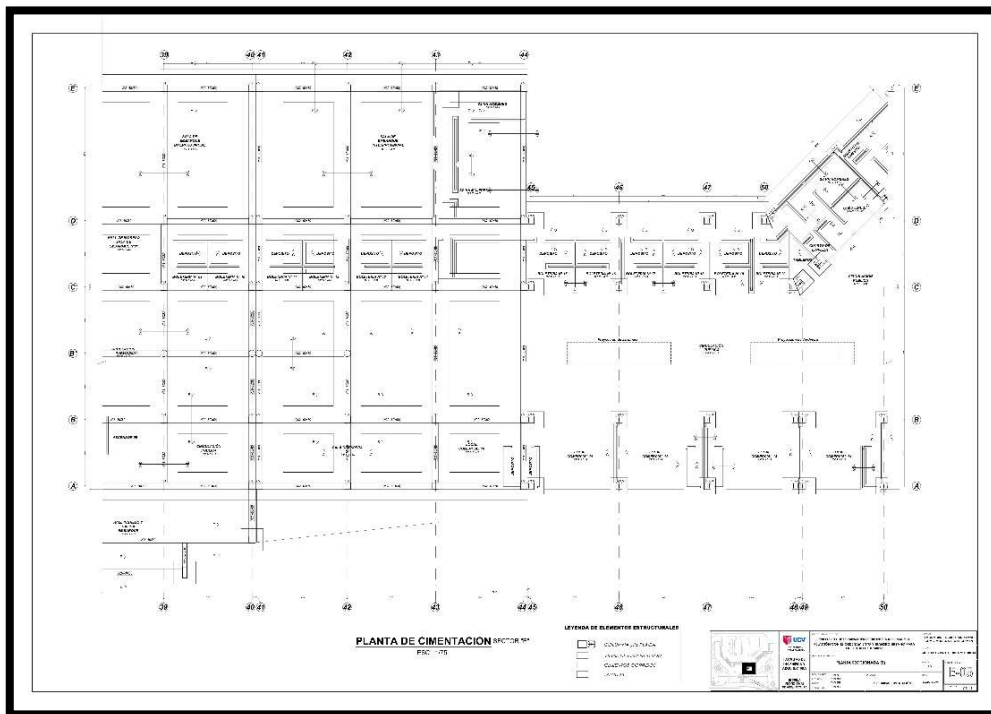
Plano de Cimentación Sector (E) Fuente: Elaboración Propia.
